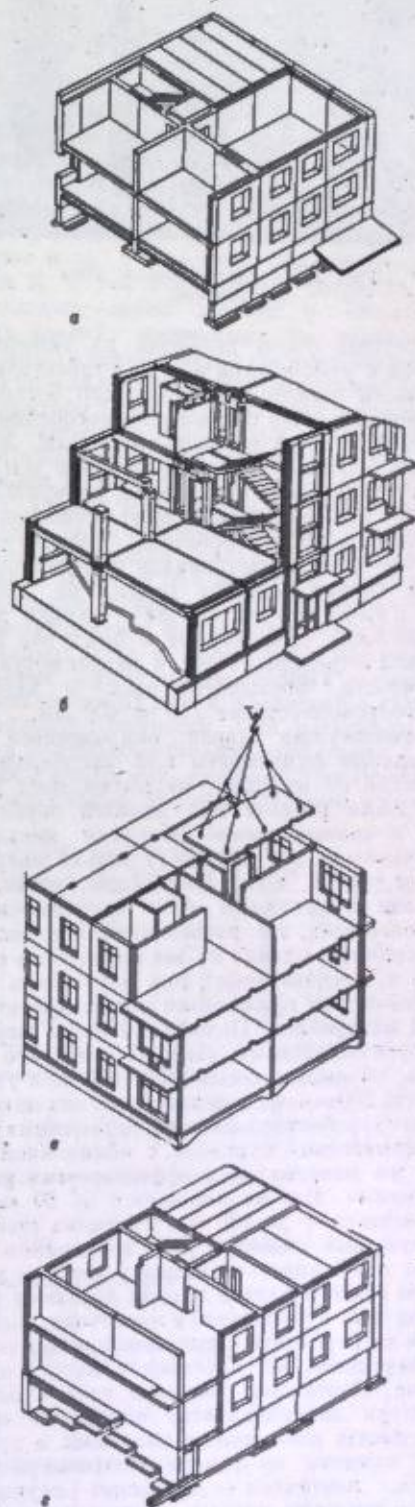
Основные типы жилых домов из крупнопанельных конструкций: а — конструктивная система с тремя продольными несущими стенами; б — то же с внутренними каркасом; в — то же с поперечными несущими перегородками (с малым шагом); г — то же с поперечными несущими стенами (с большим шагом).
